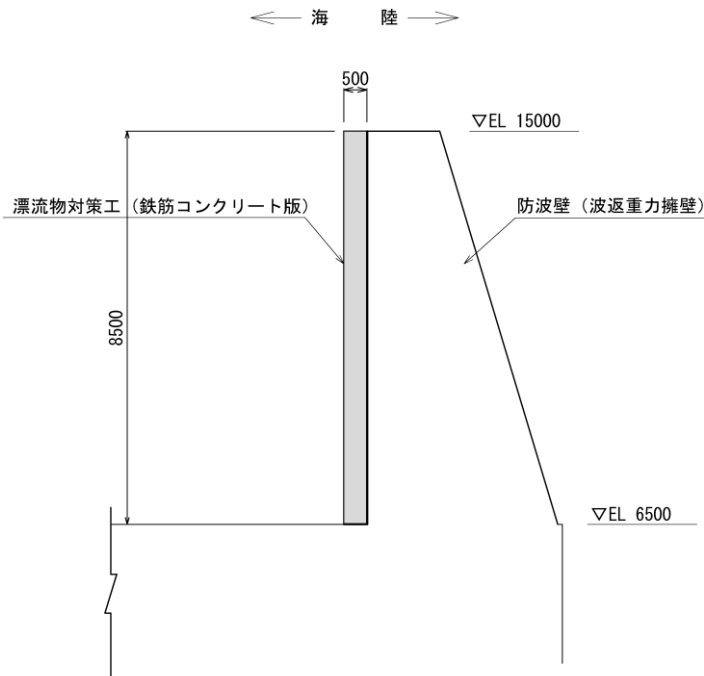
(2) 防波壁 (波返重力擁壁) 重力擁壁における漂流物対策工 (鉄筋コンクリート版) の構造概要図 (標準断面図)
